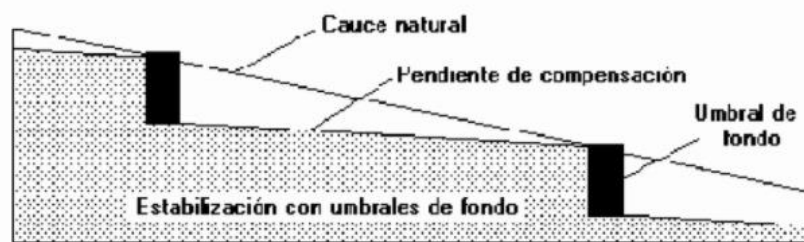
Corrección de cauce mediante umbrales de fondo. Fuente:
